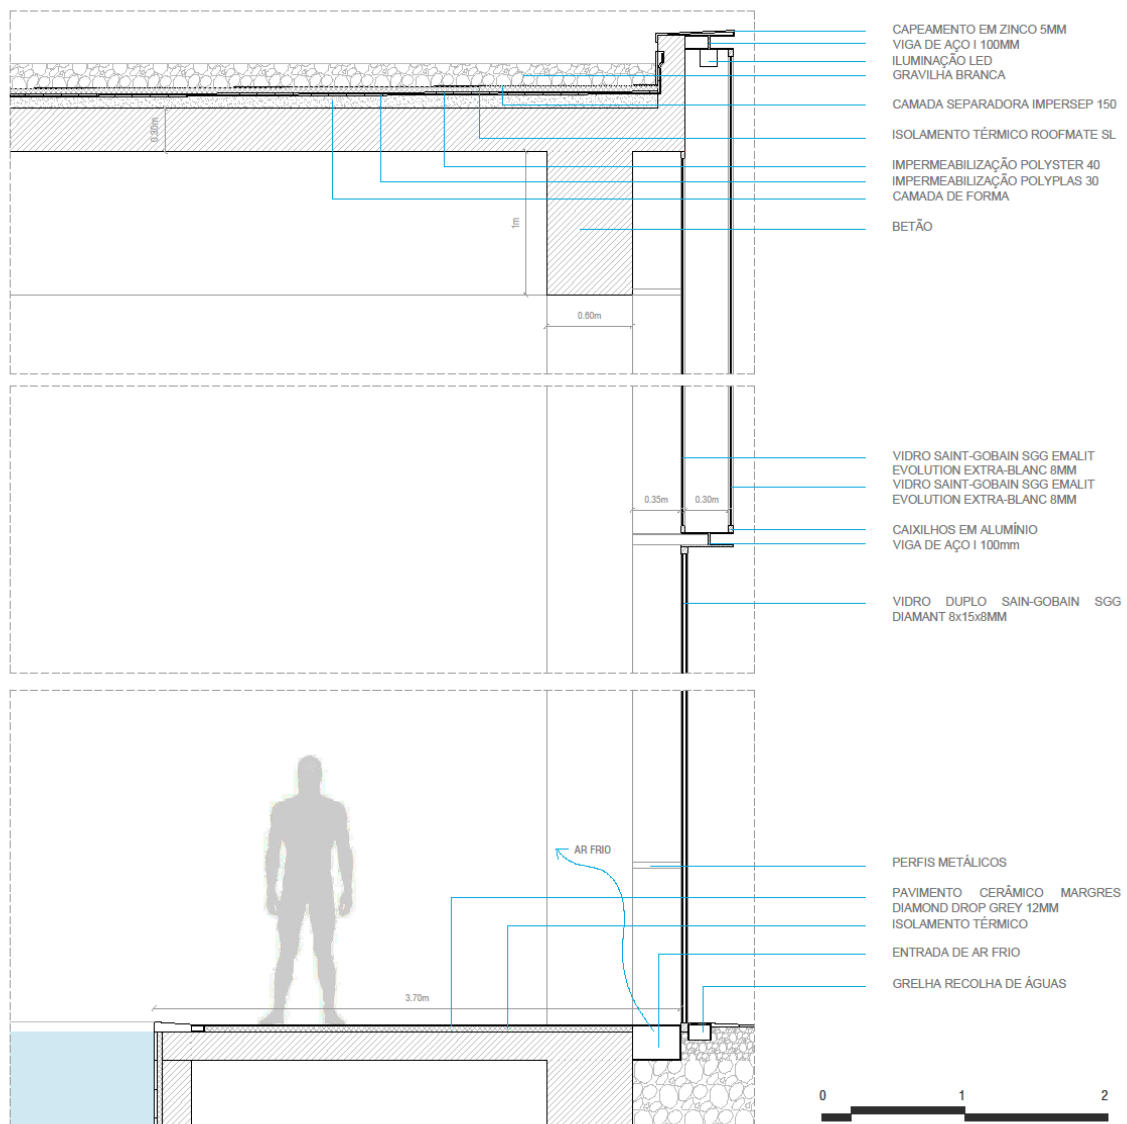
Proposta: Pormenores Construtivos, Fachada e Cobertura das Piscinas, Fonte: Autor
